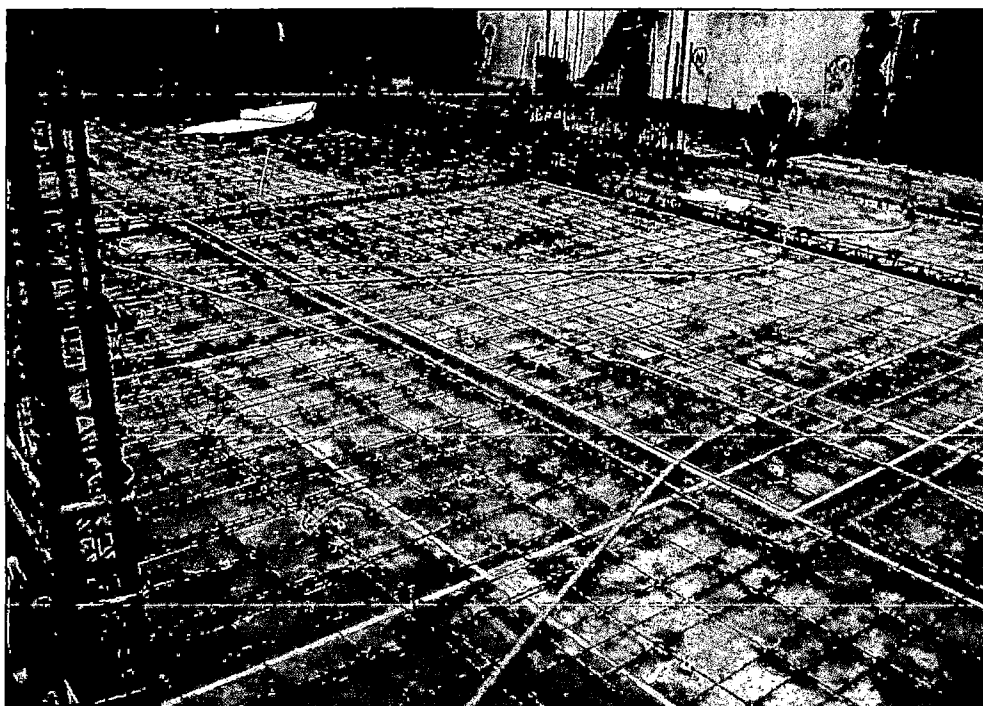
Colocación del acero de refuerzo en una losa maciza
